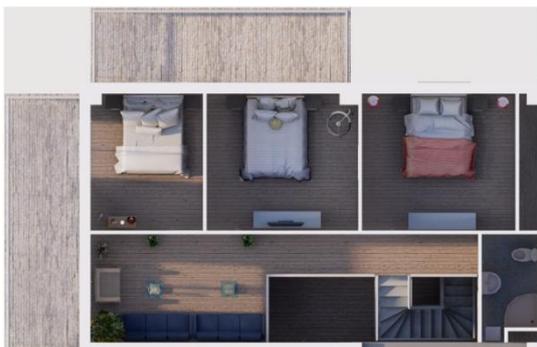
3D, Plan et tableau des surfaces types 04.
